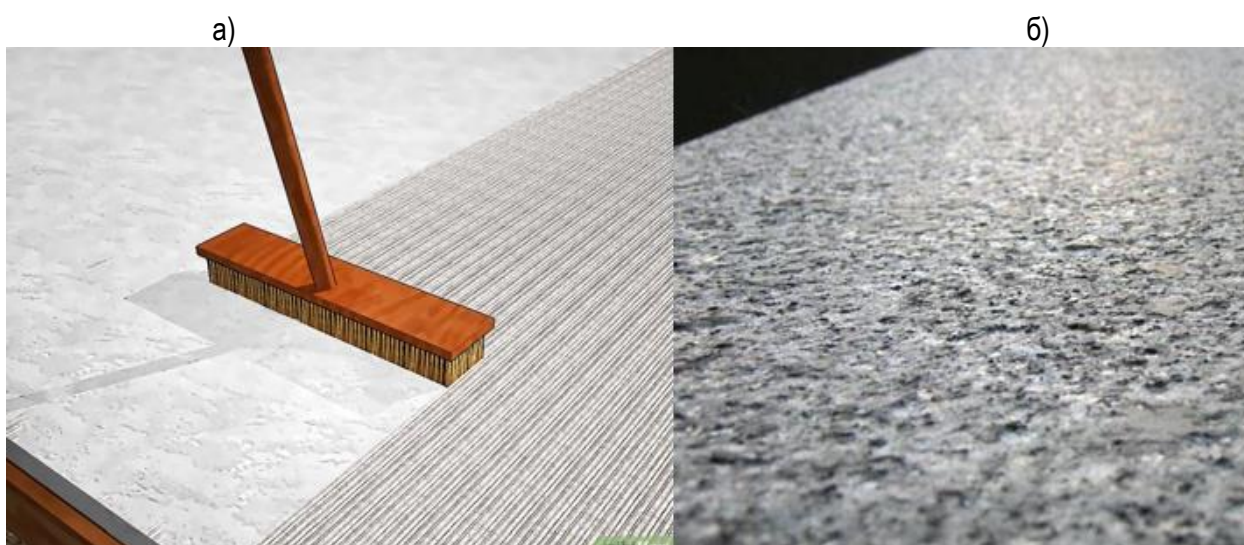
а) Бетон с отделкой шваброй; б) Обожженный гранит
